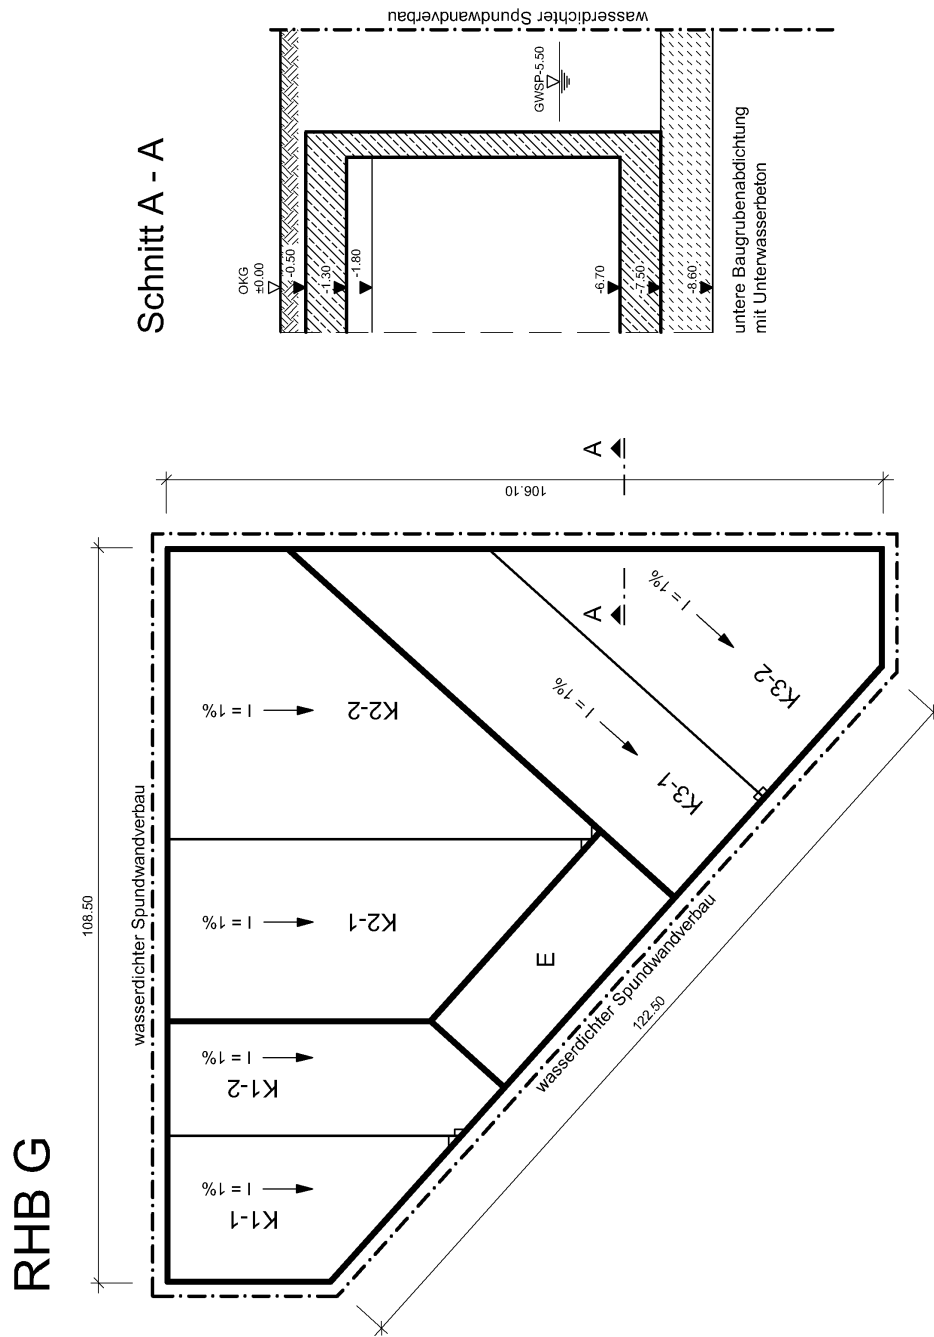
Grundriss und Schnitt RHB G
